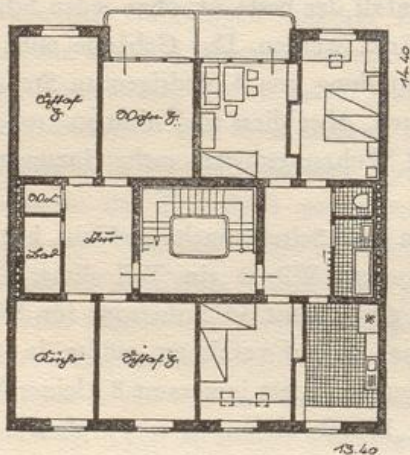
Wiederaufbau eines Wohnhauses in einer Baulücke
